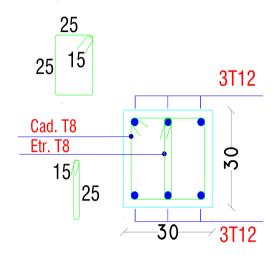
coupe de ferraillage des longrines aux niveaux d'appuis et travée
